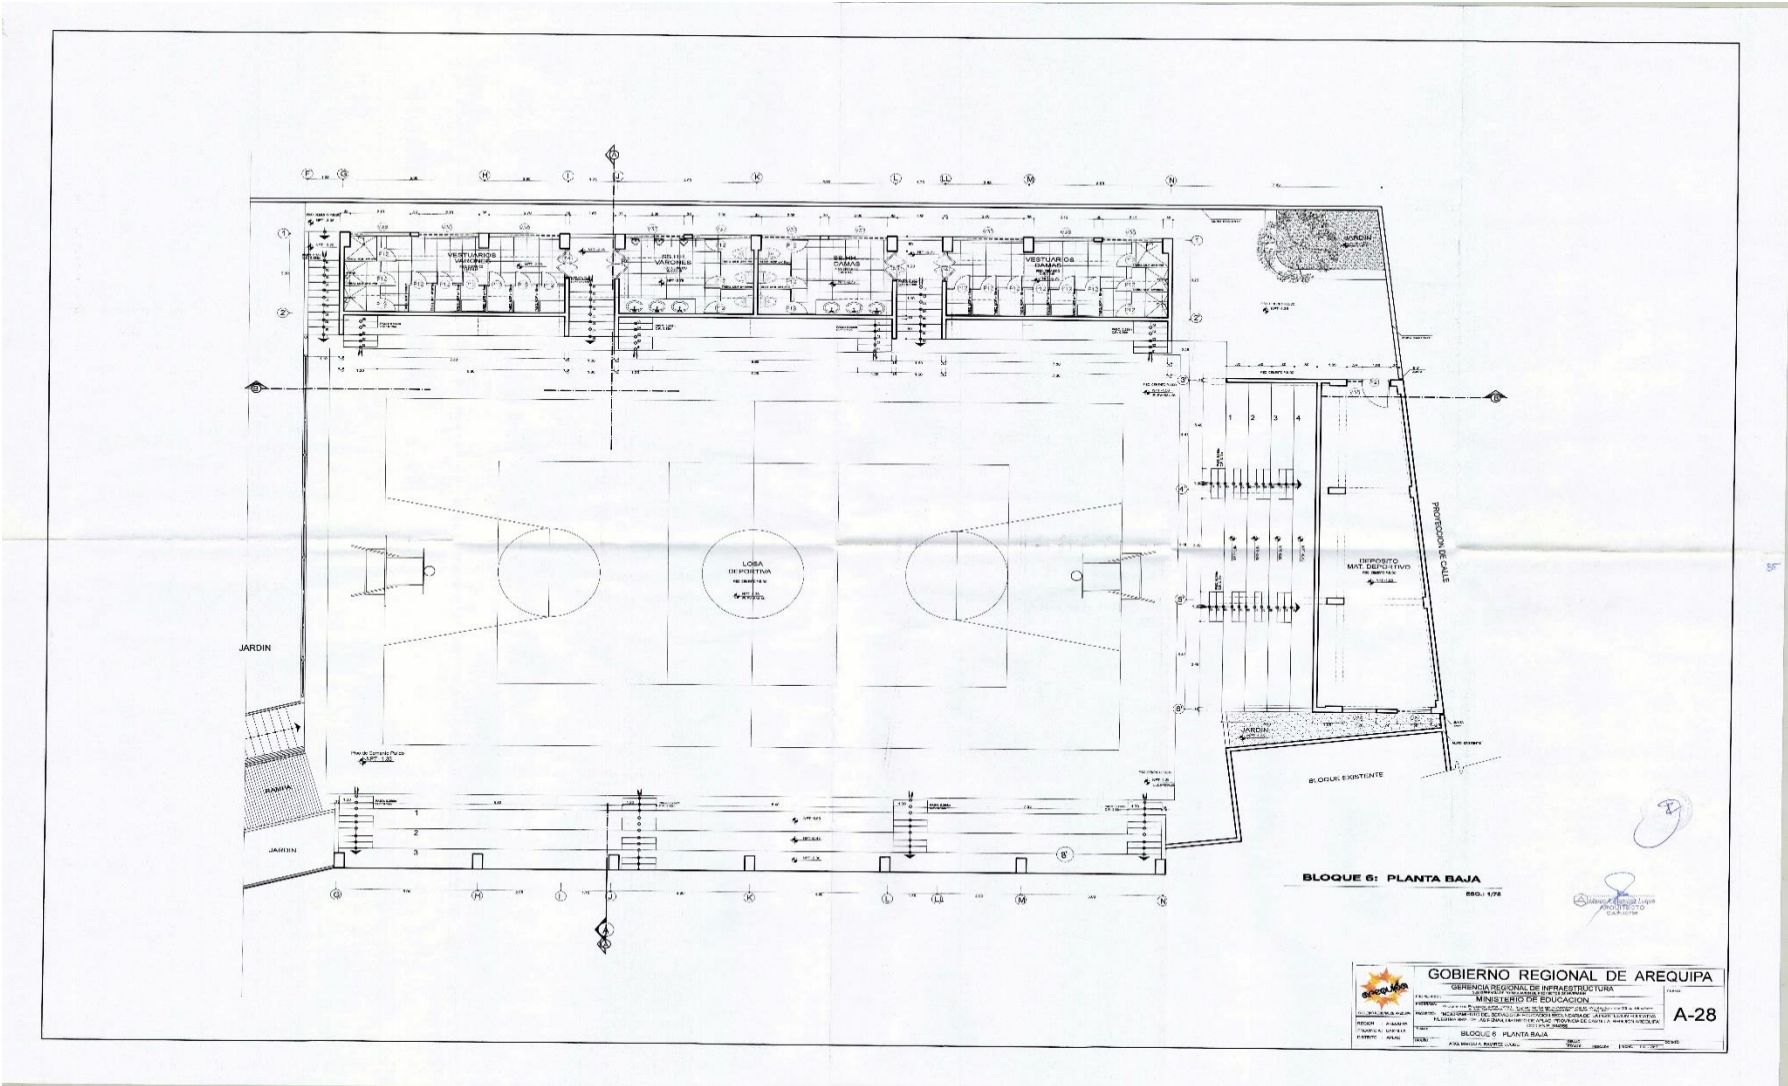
Plano de arquitectura – Planta del bloque 06 losa deportiva.
